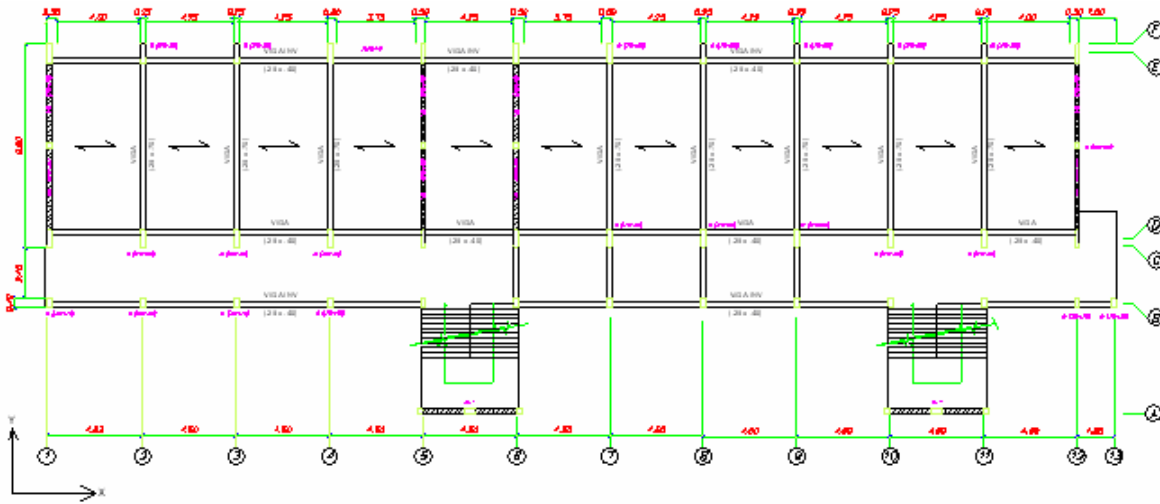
Planta del sistema estructural del Edificio de educación superior pre NDSR-1997
